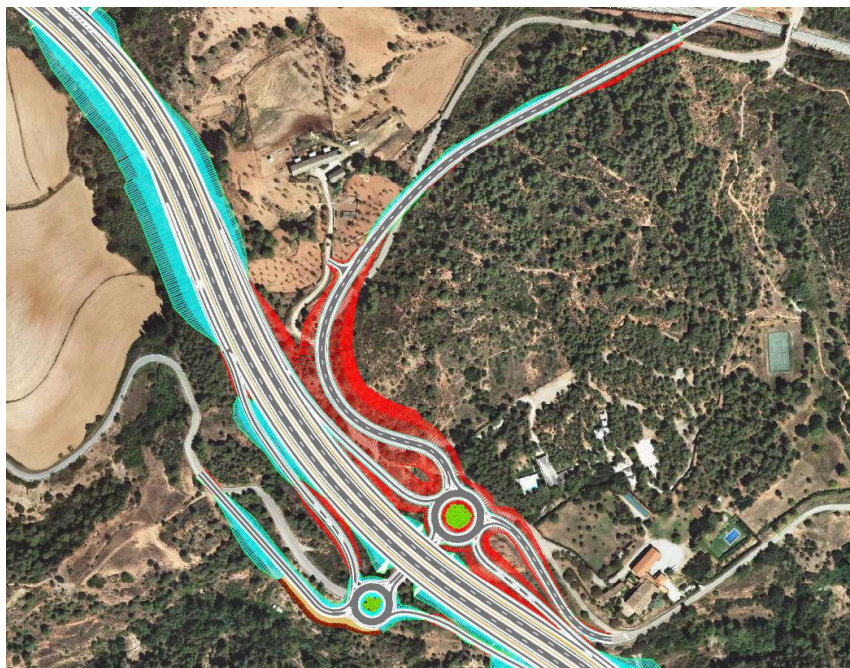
vista en planta d'un tram del traçat, el del nus de connexió amb la C-16.
